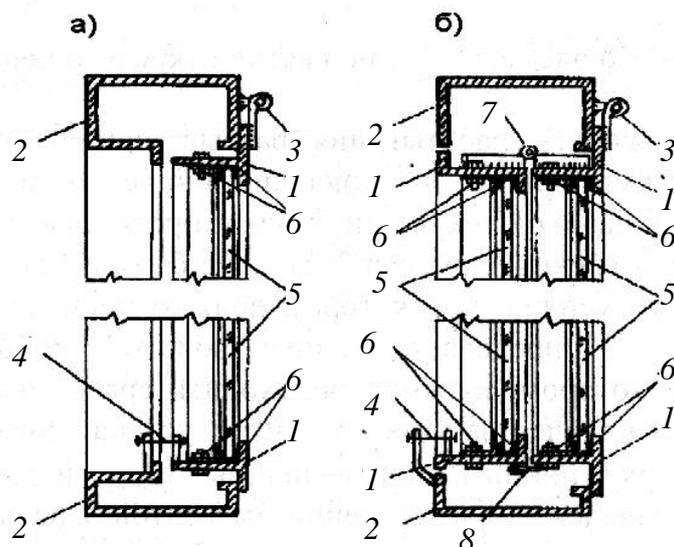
Разрез оконной рамы с открывающимся переплетом с верхним горизонтальным шарниром:
